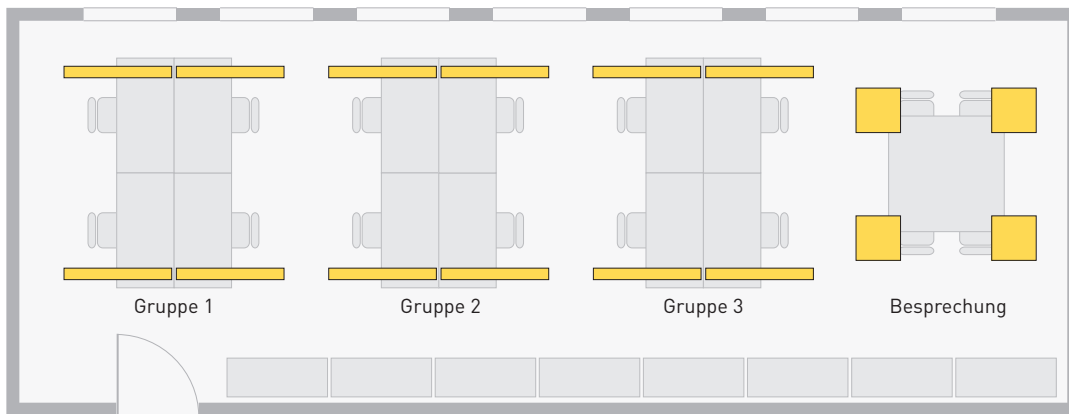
Grundriss eines Gruppenbüros
